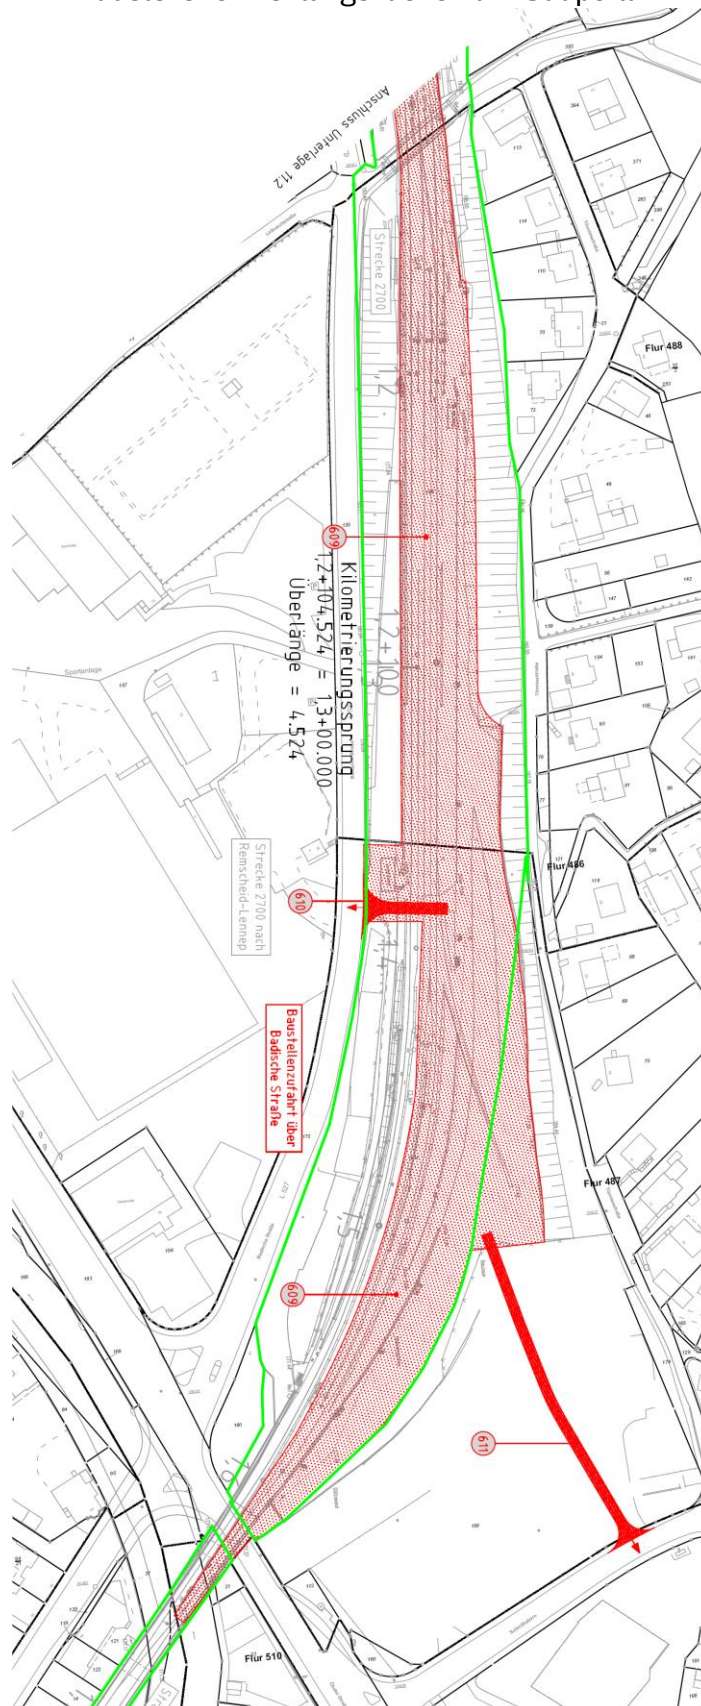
Baustelleneinrichtungsflächen und Arbeitsraum
